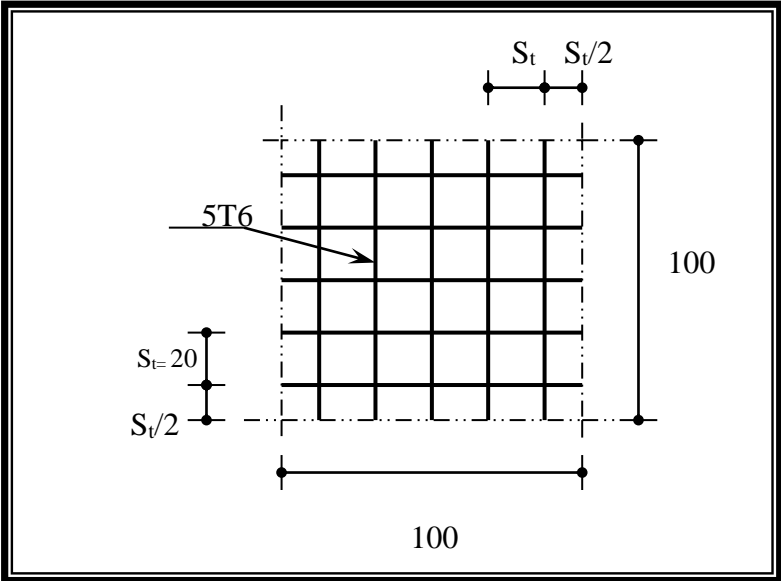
Disposition constructive des armatures de la dalle de compression
